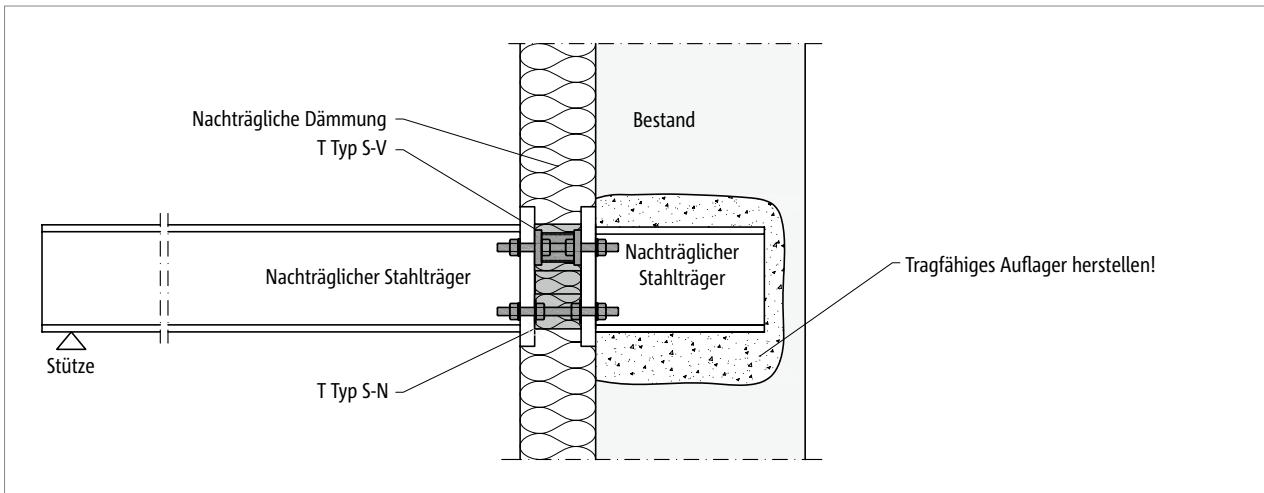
Schöck Isokorb® T Typ S-N und T Typ S-V: Nachträglicher Stahlbalkon gestützt; angeschlossen an nachträglich eingebautes Wandauflager
